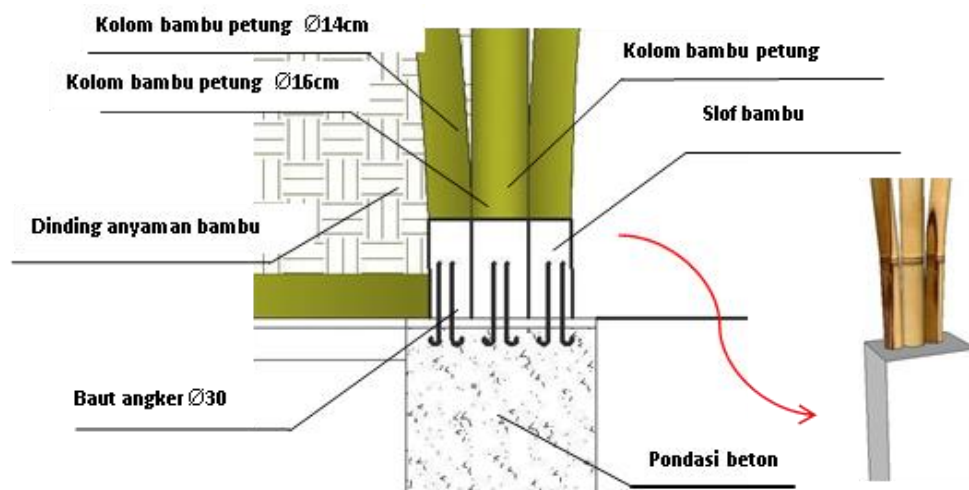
Konsep Bangunan Penginapan Ret – Ret
